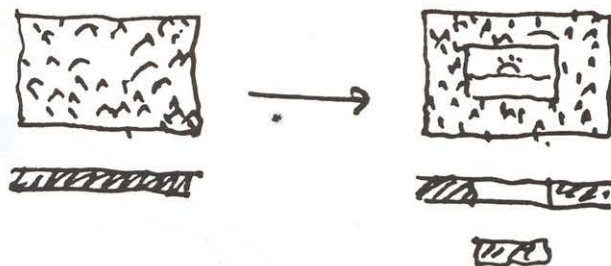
La sustracción en el muro estereotómico. Análisis en planta y alzado.
